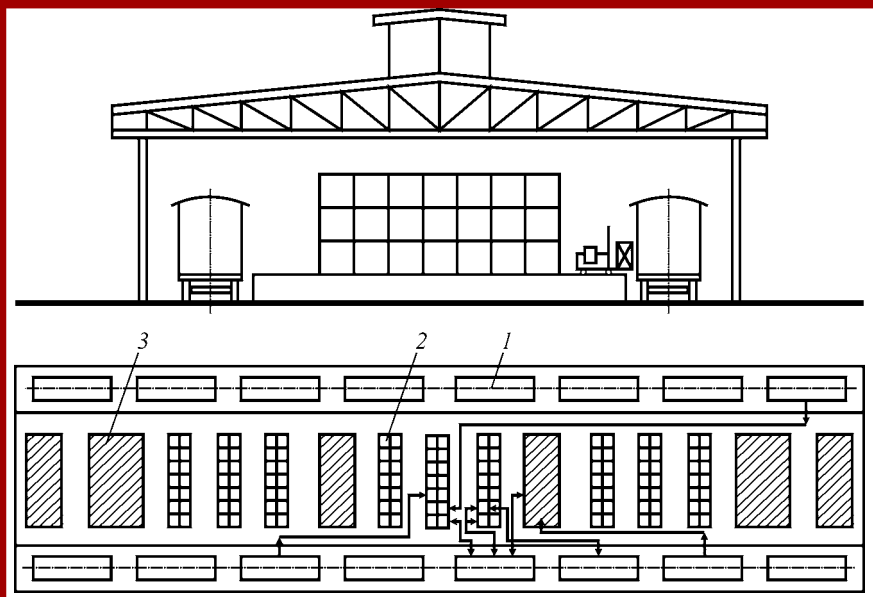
Схема переработки мелких отправок на грузосортировочной площадке: 1 — вагон; 2 — стеллажи; 3 — площадки для временного хранения груза
